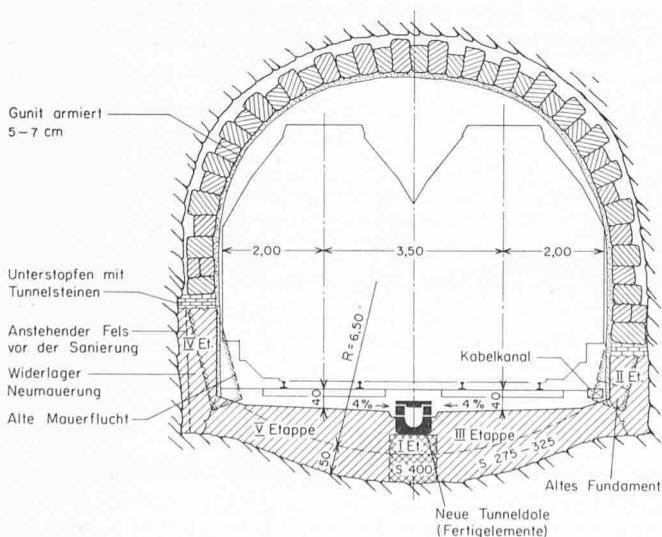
Typisches Profil mit Sohlengewölbe im Anhydrit (Rekonstruktion Bözbergertunnel 1963-67)
